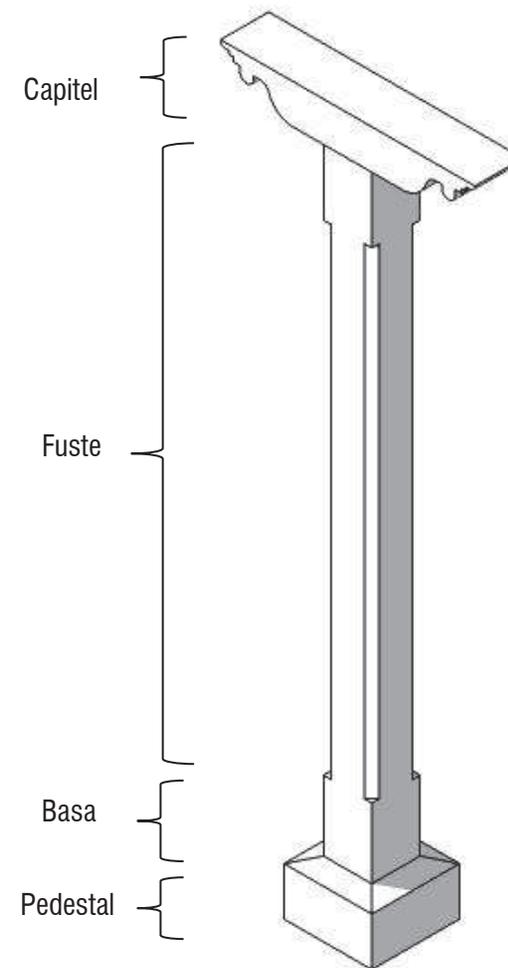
columna pasillo exterior, casa parroquial
